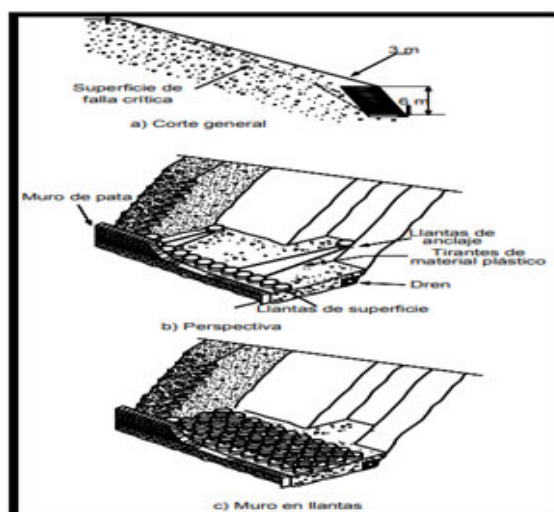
Muro en llantas usadas, utilizando llantas con tirantes como elemento de anclaje.
